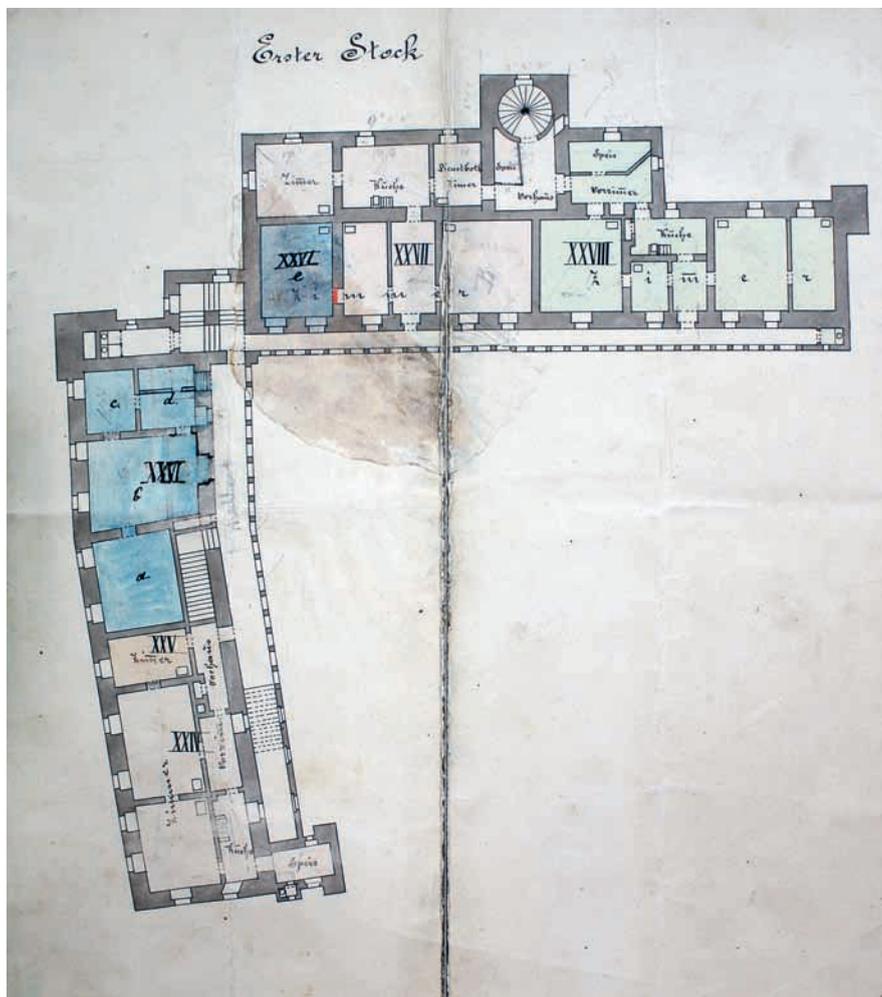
Schloss Lundenburg (Břeclav). Plan des Schlosses. Grundriss des ersten Stocks. (Mährisches Landesarchiv, Foto Tomáš Knoz)
